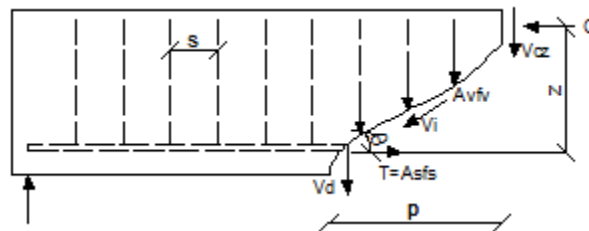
6 Fuerzas en el plano de falla de una viga con estribos verticales.
